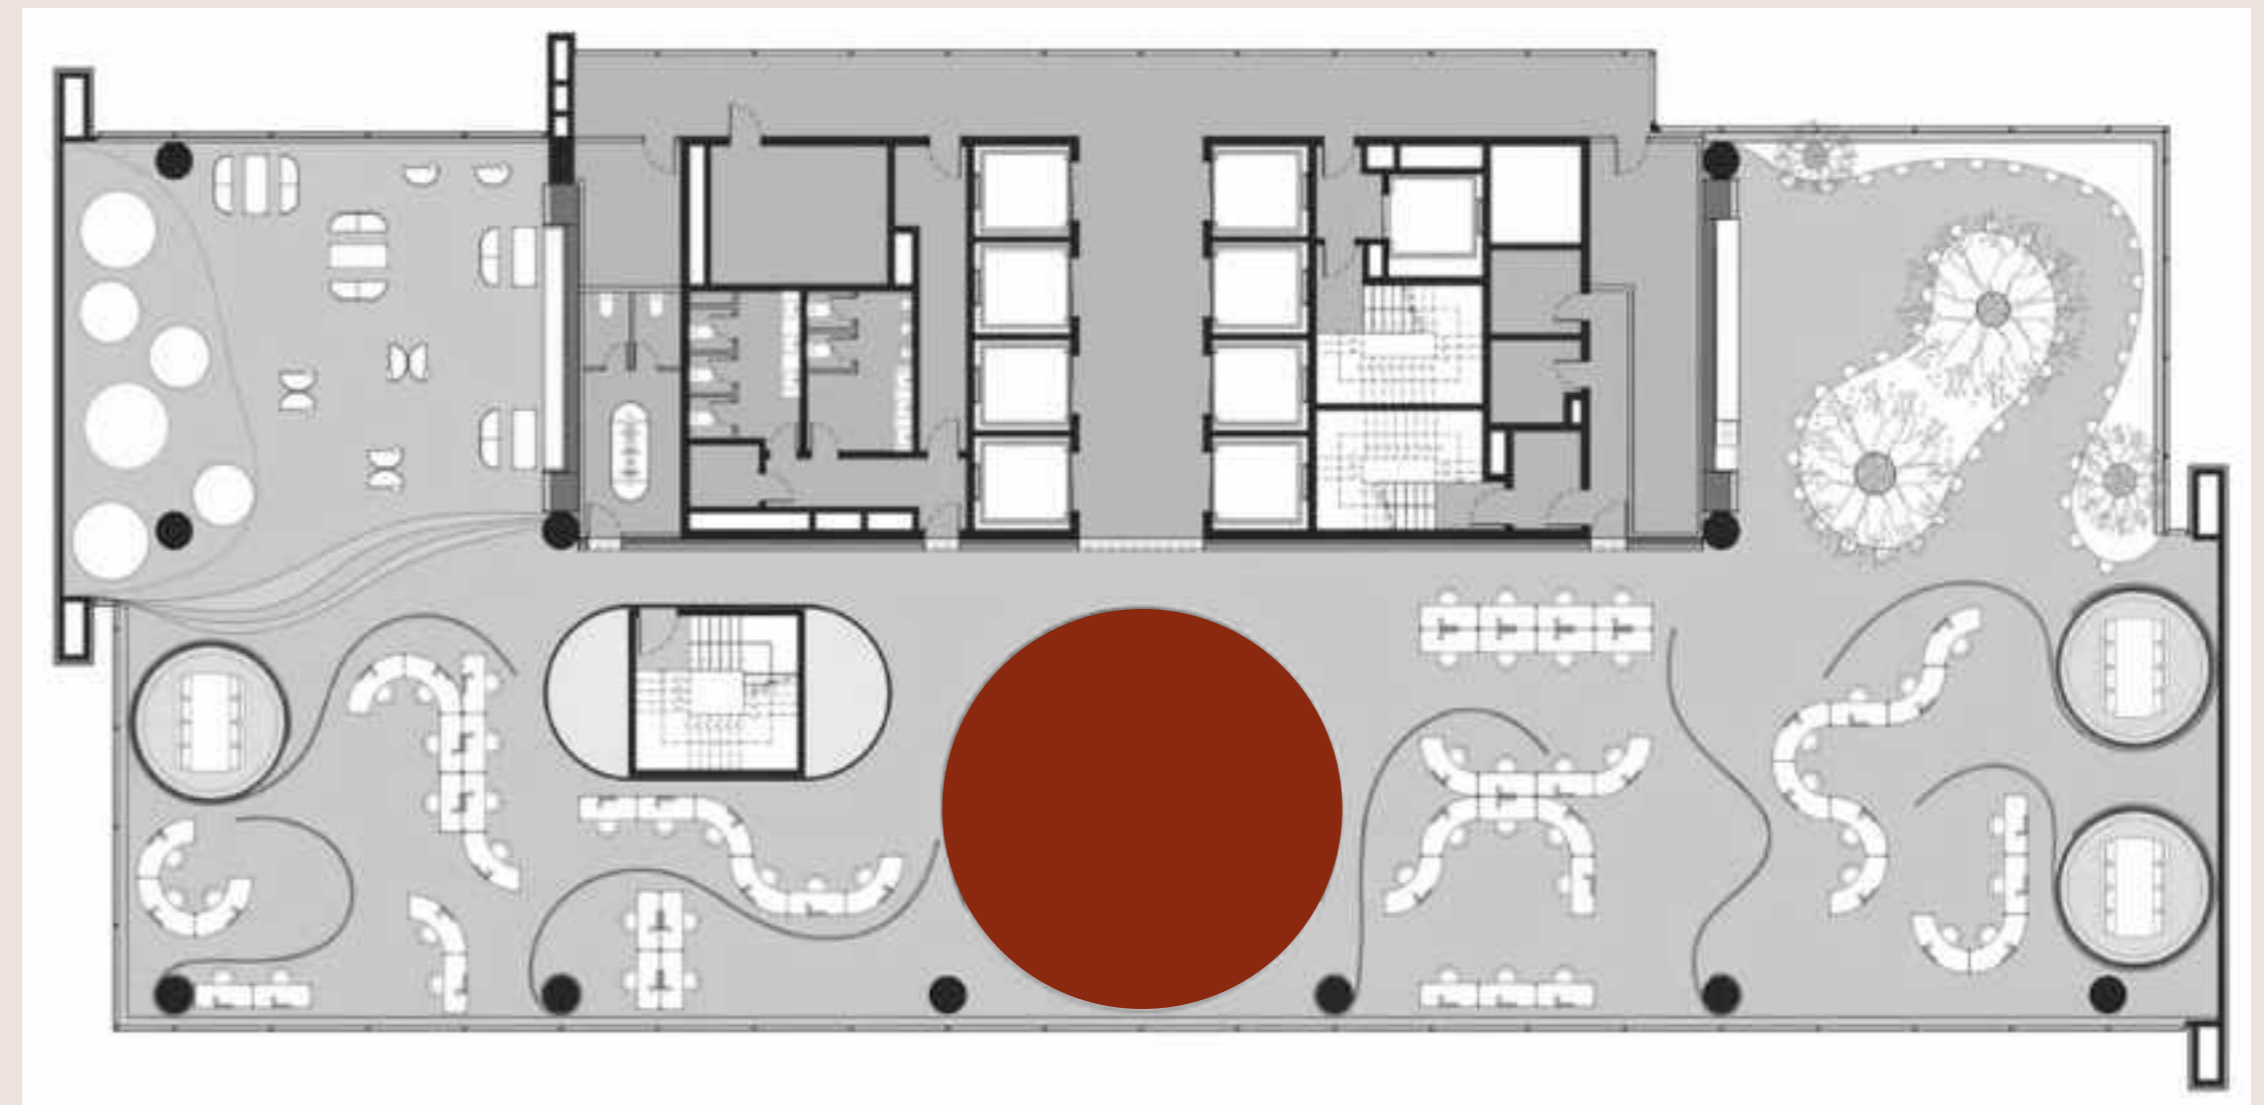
Planta layout projeto Google Cell e o núcleo em destaque
